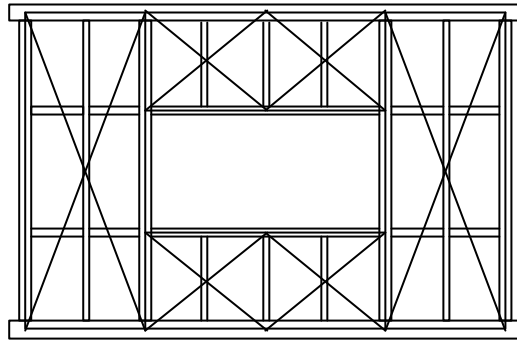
Mur de contreventement P3 (fenêtre). Shear wall P3 (window)
